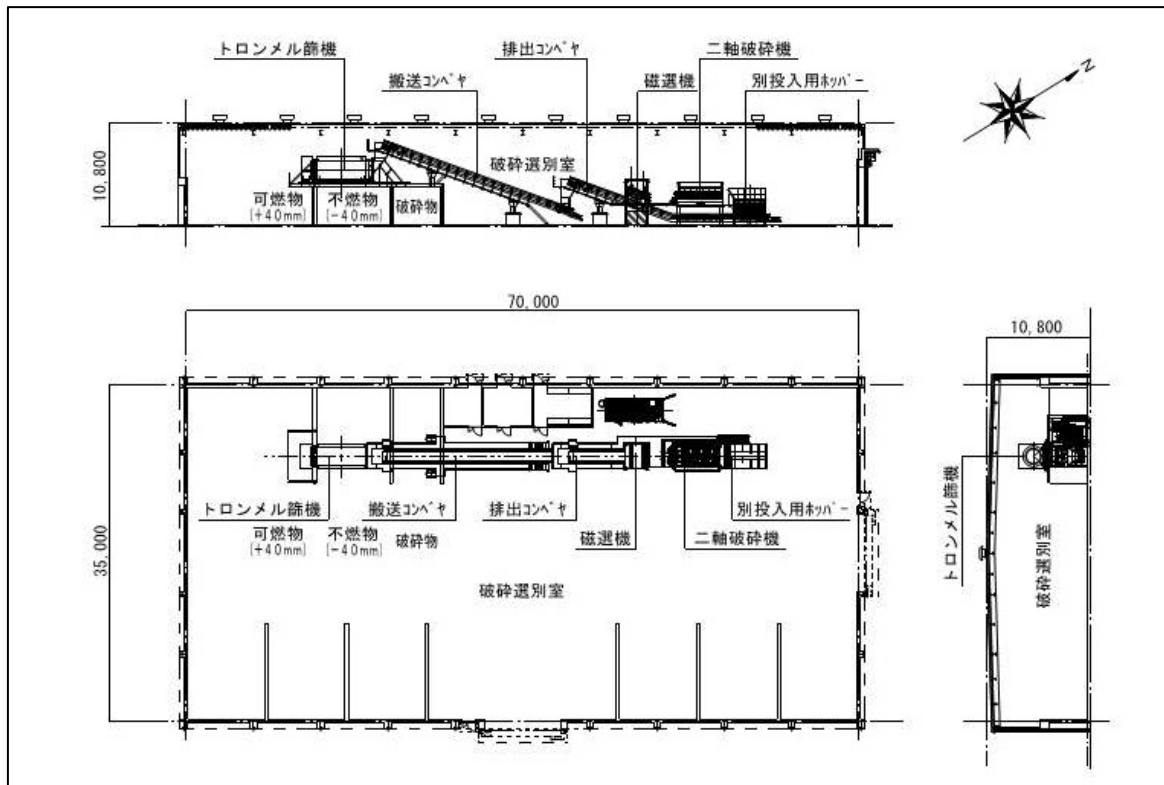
設備機器の平面図・断面図（リサイクル施設（選別破碎施設））
